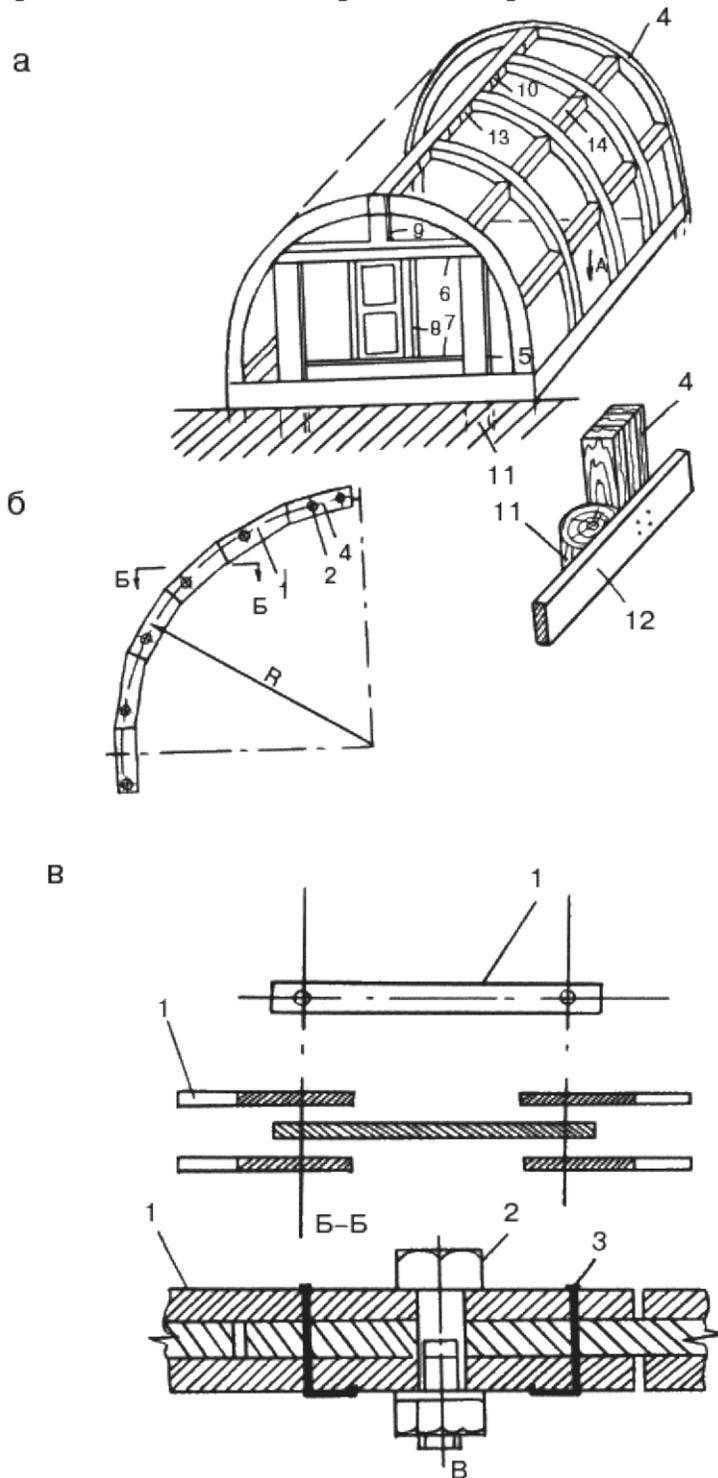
Арочная теплица с каркасом из реек: а — общий вид; б — дуга, собранная из планок; в — порядок монтажа дуги; 1 — планки; 2 — болты; 3 — гвозди; 4 — дуги
